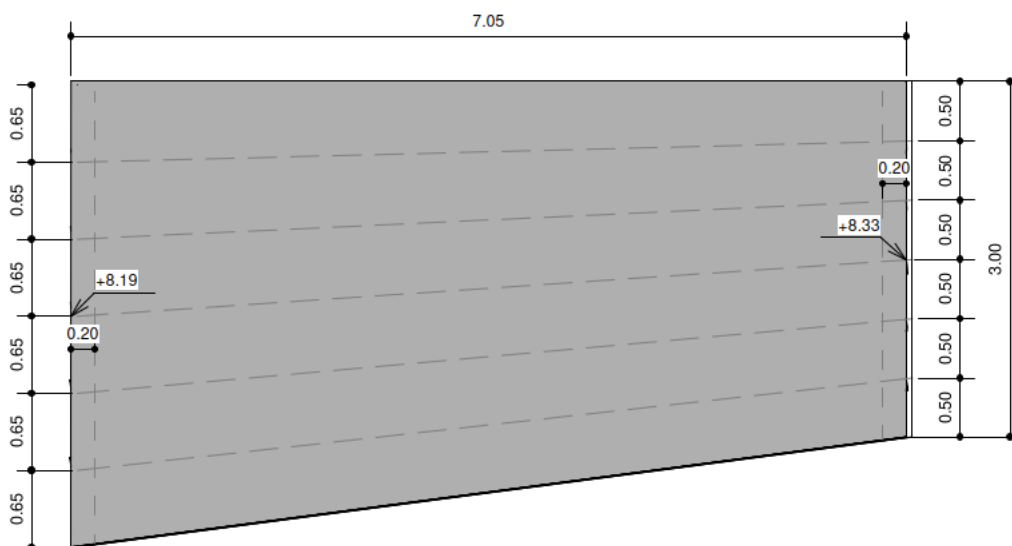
Vue en plan du platelage de type 6 (platelage d'extrémité rive gauche)
